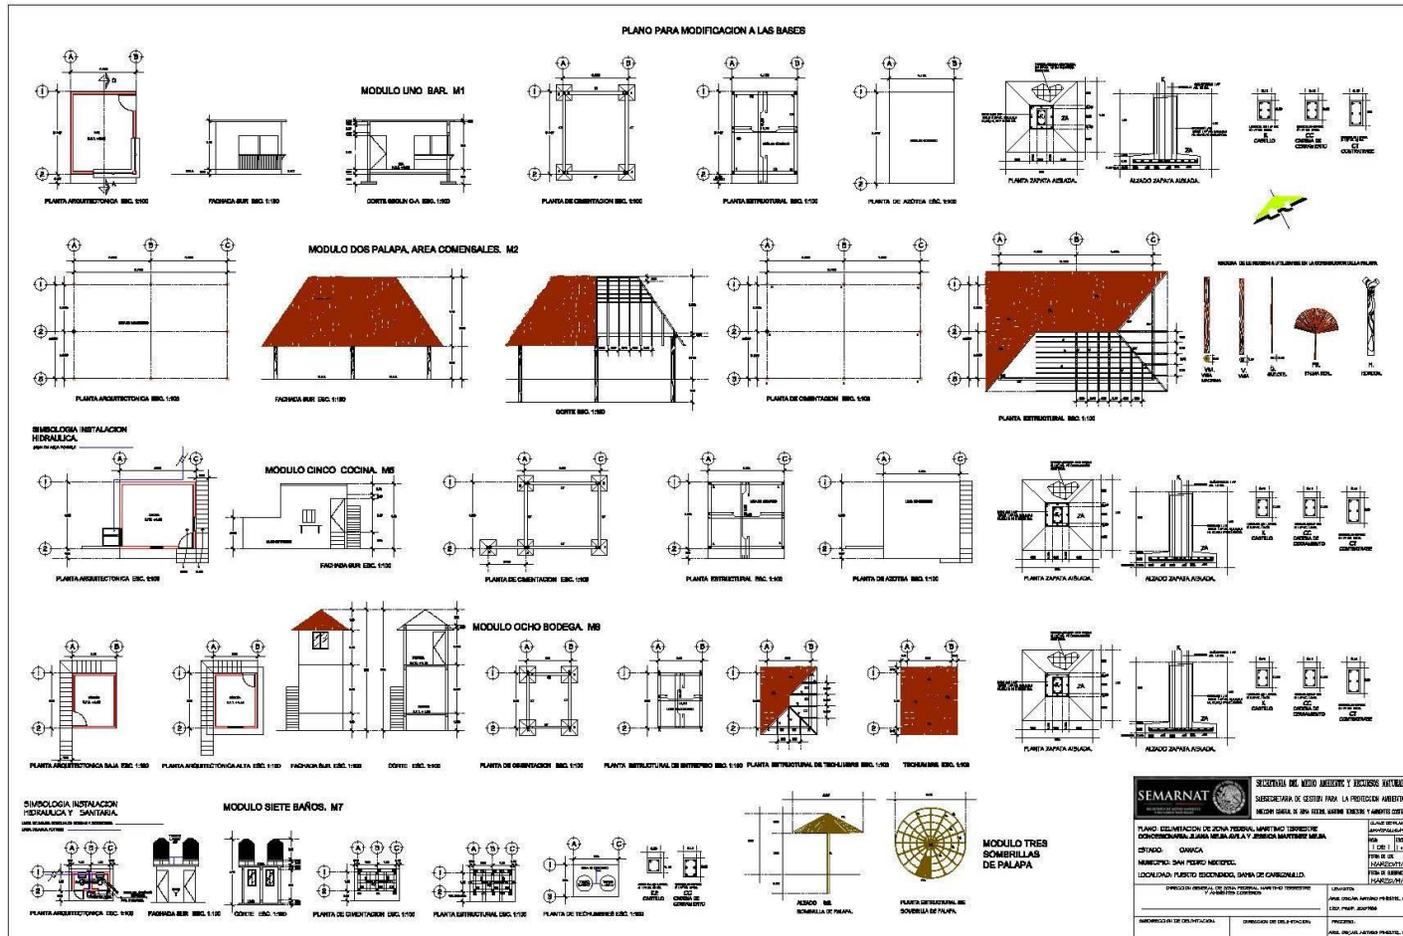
Plano arquitectónico de las obras a remodelar.
